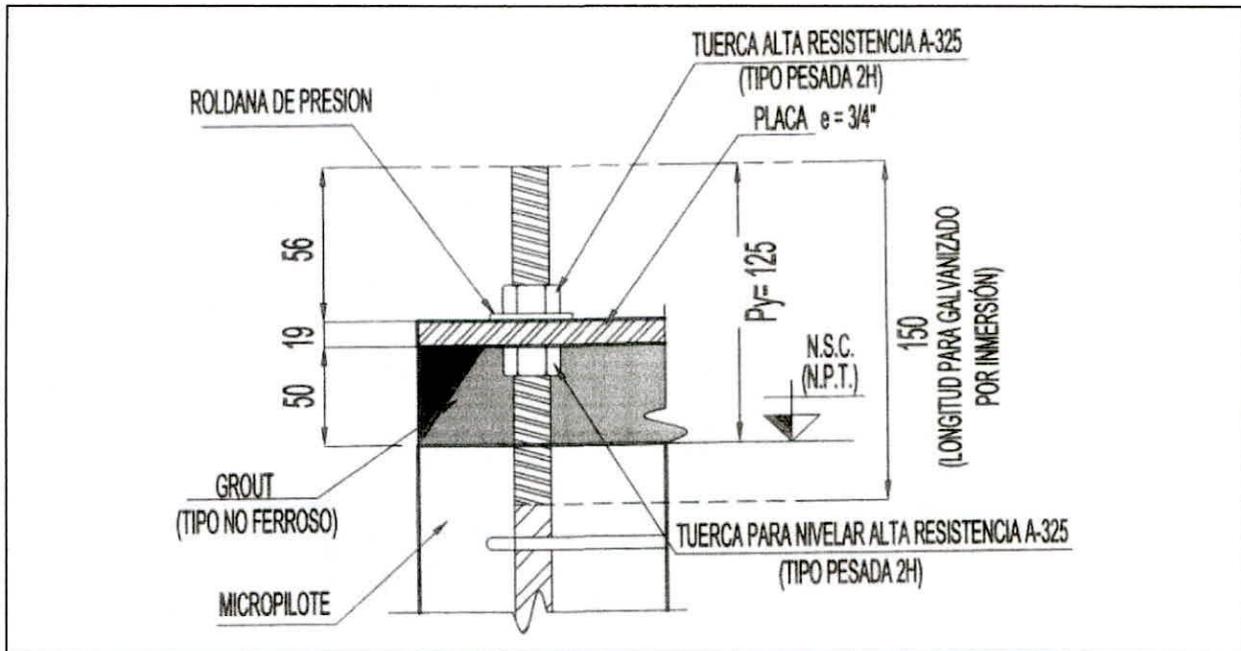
Detalle "A" de Anclaje de Cimentación de poste de 9 a 11 metros
